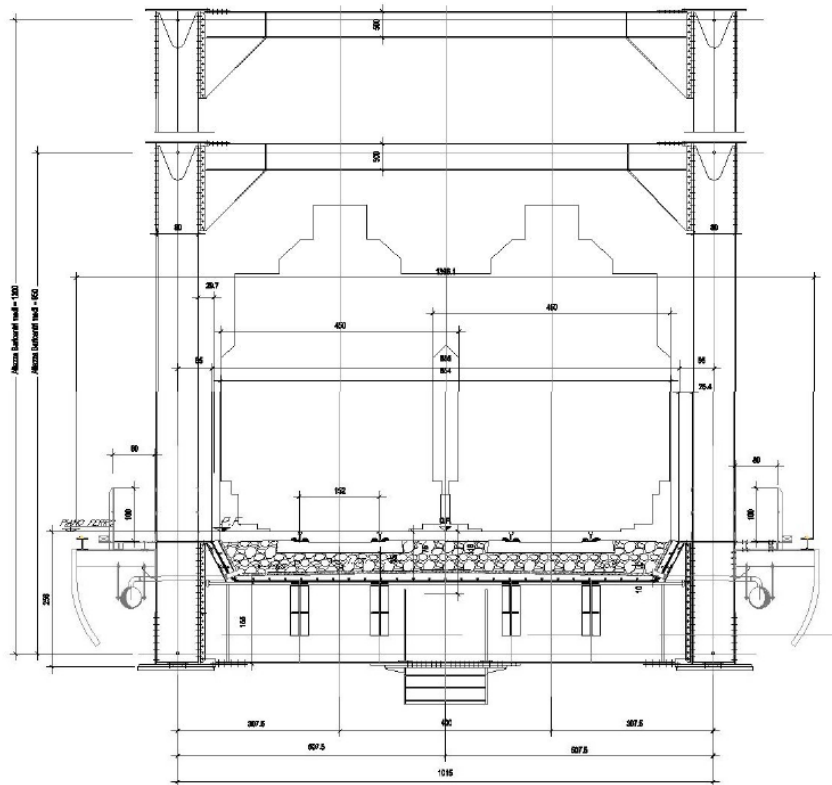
Sezione trasversale impalcato in acciaio da L=70m
